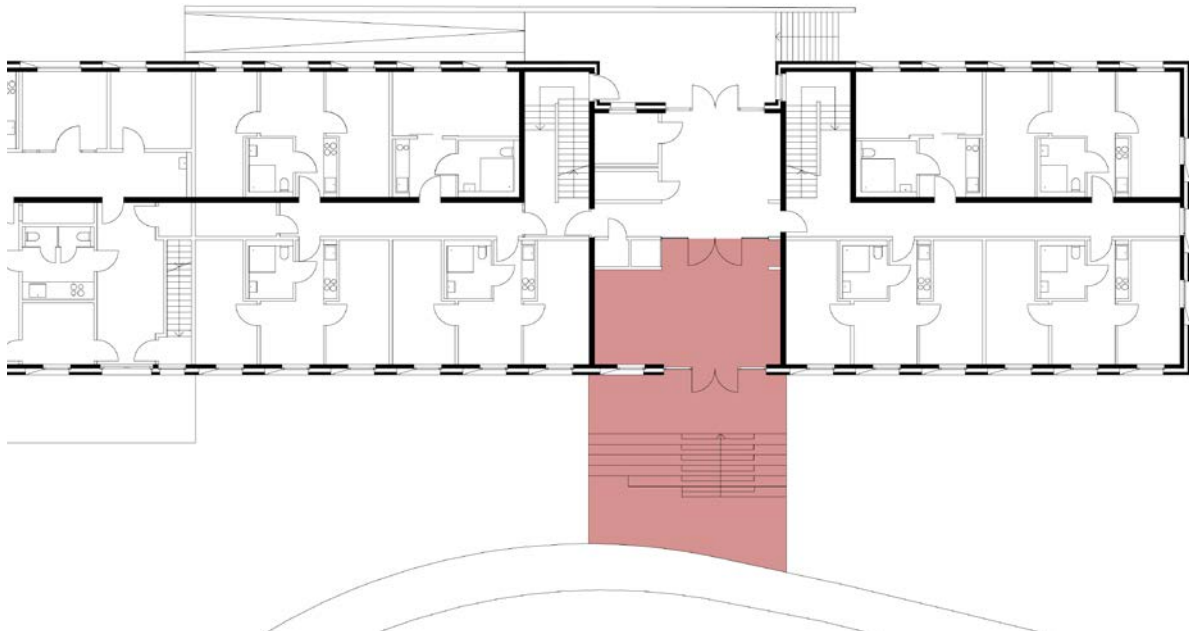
Heiligenhaus: Grundriss EG; Gemeinschaftsraum mit vorgelagerter Terrasse, Treppe mit Sitzstufen und Zugang zum Campus-Park. Erschließung der Zimmer von zentralem Foyer über Treppenhäuser und Flure als gut gelöster Übergang zwischen öffentlichen/halböffentlichen und privaten Bereichen. [© BF Vario]
